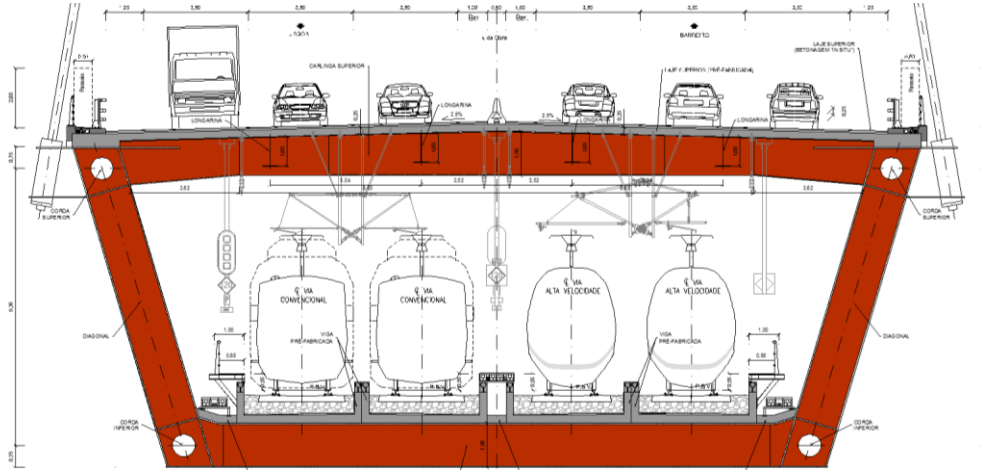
Proposta da secção transversal mista aço-betão, Eng.º Adão da Fonseca [91]
